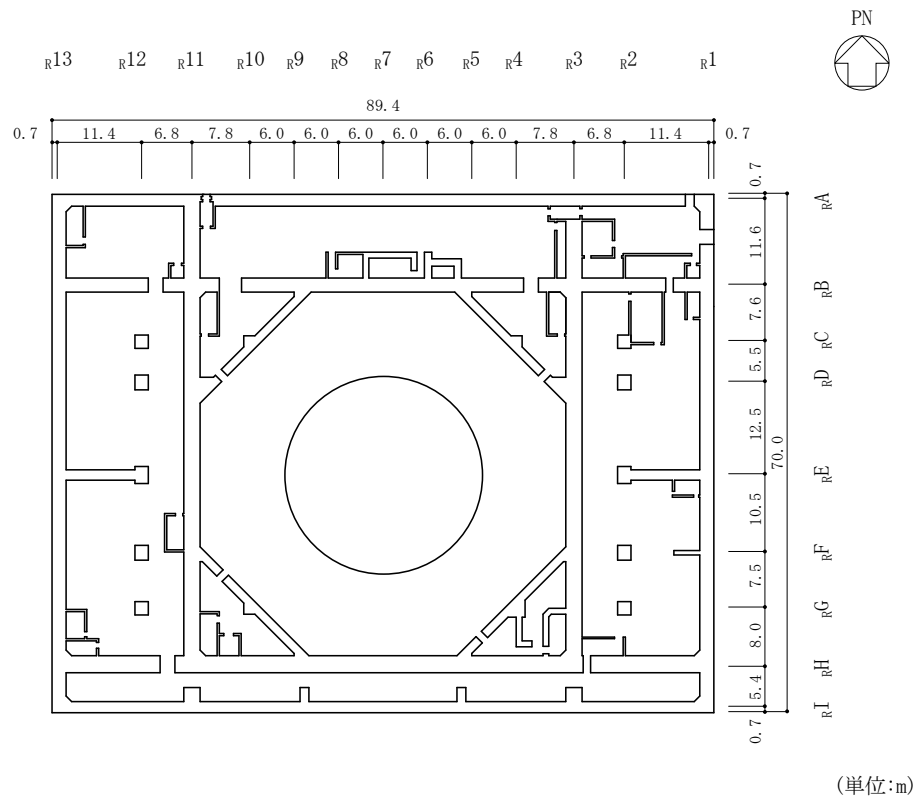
(2) 原子炉建物の概略平面図 (EL 8.8m)
